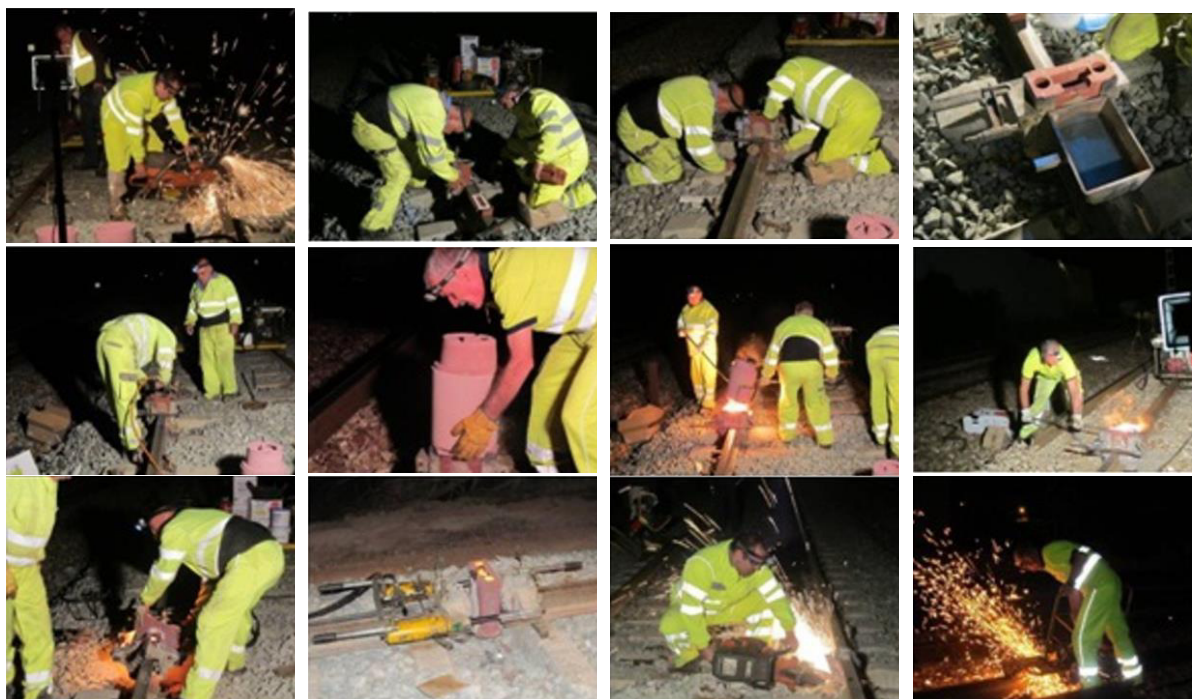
Execução de Soldadura Aluminotérmica [26]
